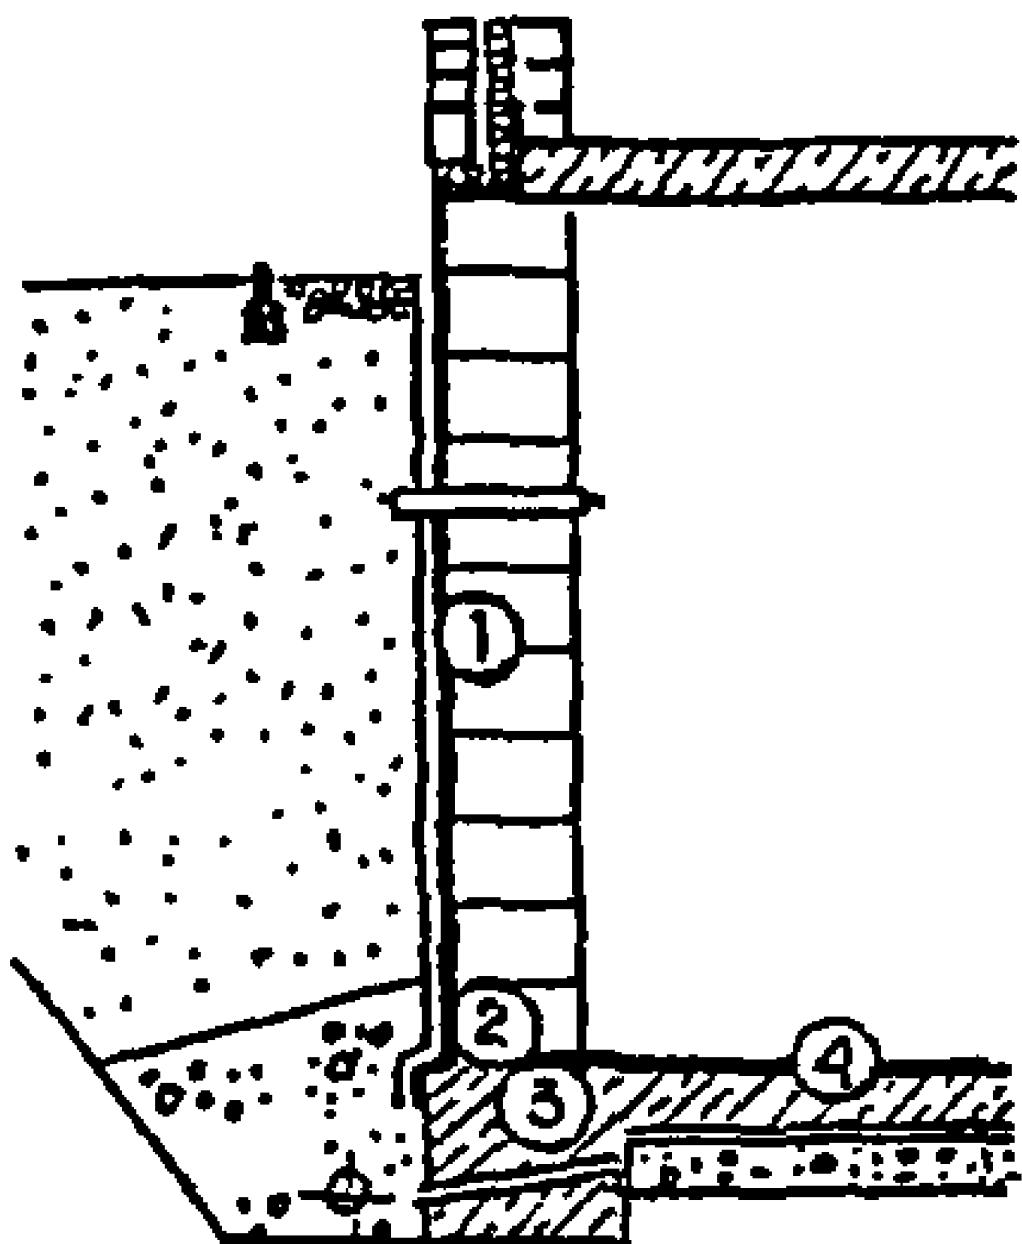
Гидроизоляция подвалов и фундаментов в новостройках:
